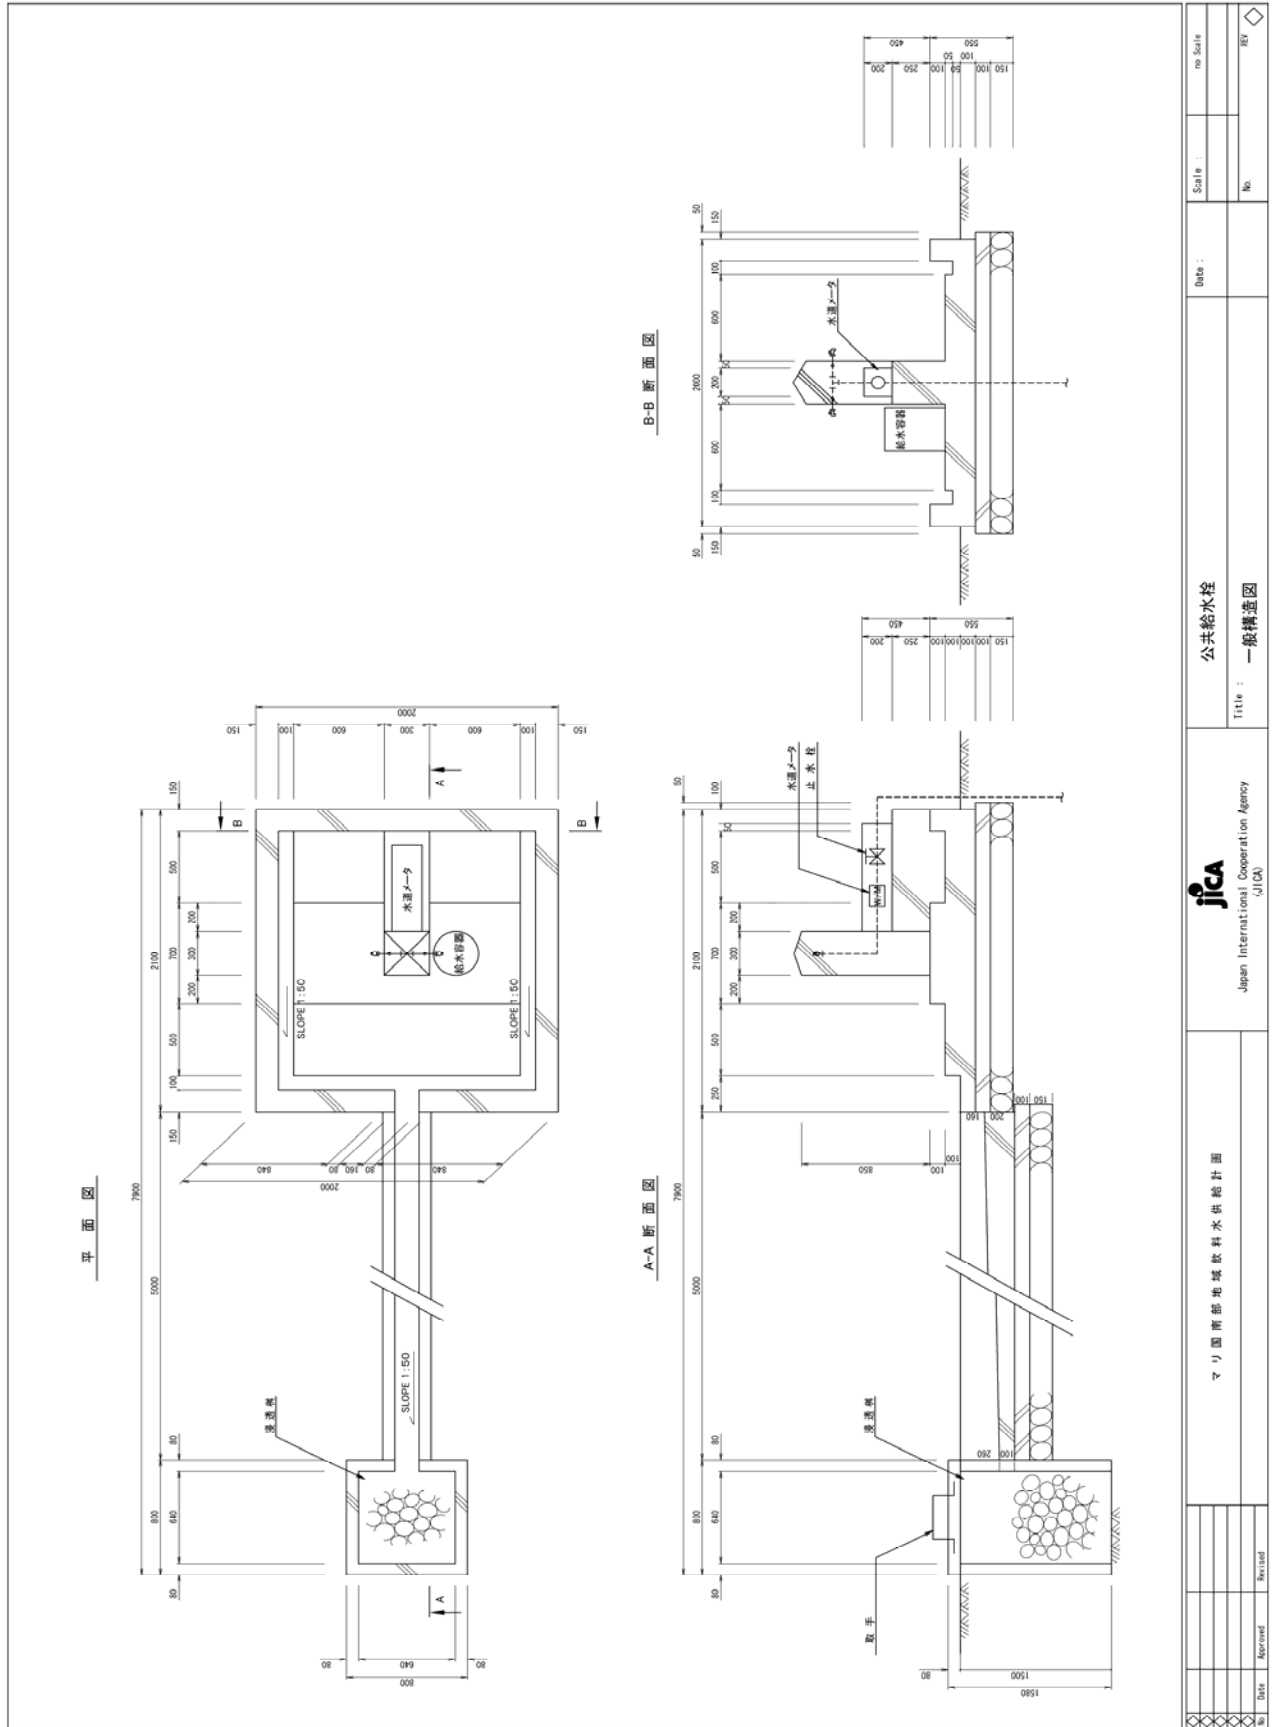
レベル2 給水施設 (公共水栓標準配置図)
